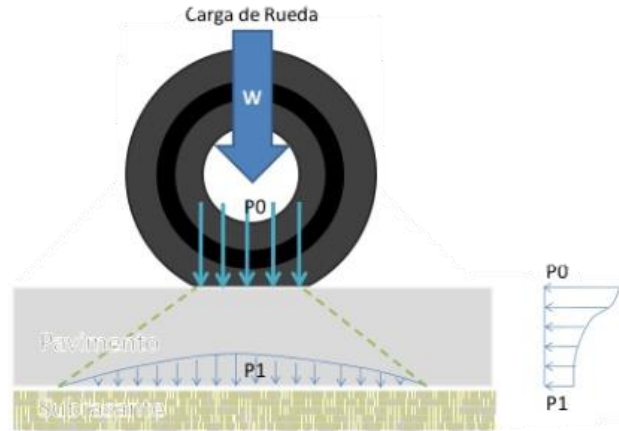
Distribución de esfuerzos en las capas de un pavimento con asfalto espumado (García, 2018).
